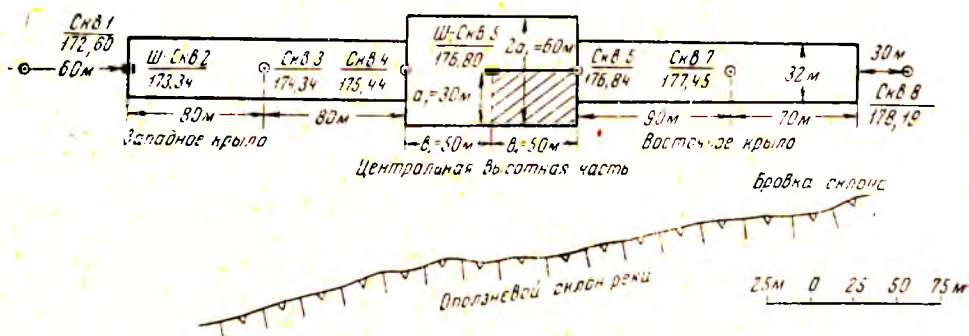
Схема расположения здания и разведочных выработок первой очереди
